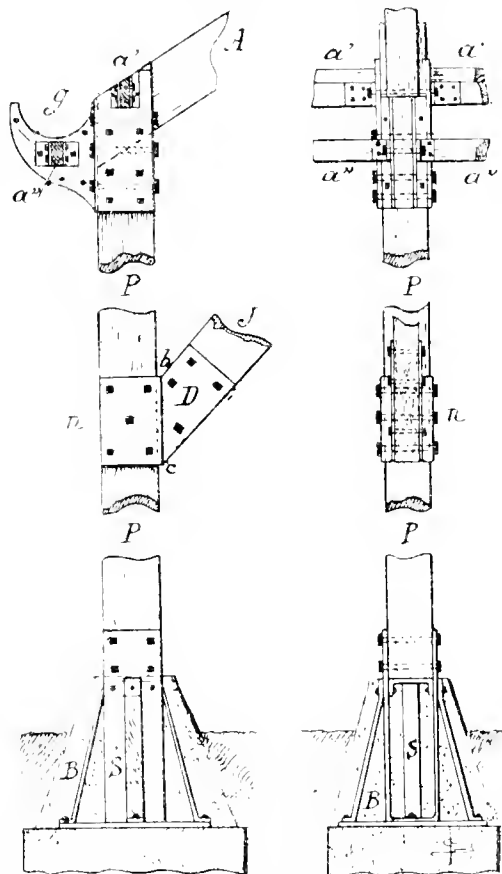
Assemblage des arbalétriers et des aisseliers sur les poteaux.
